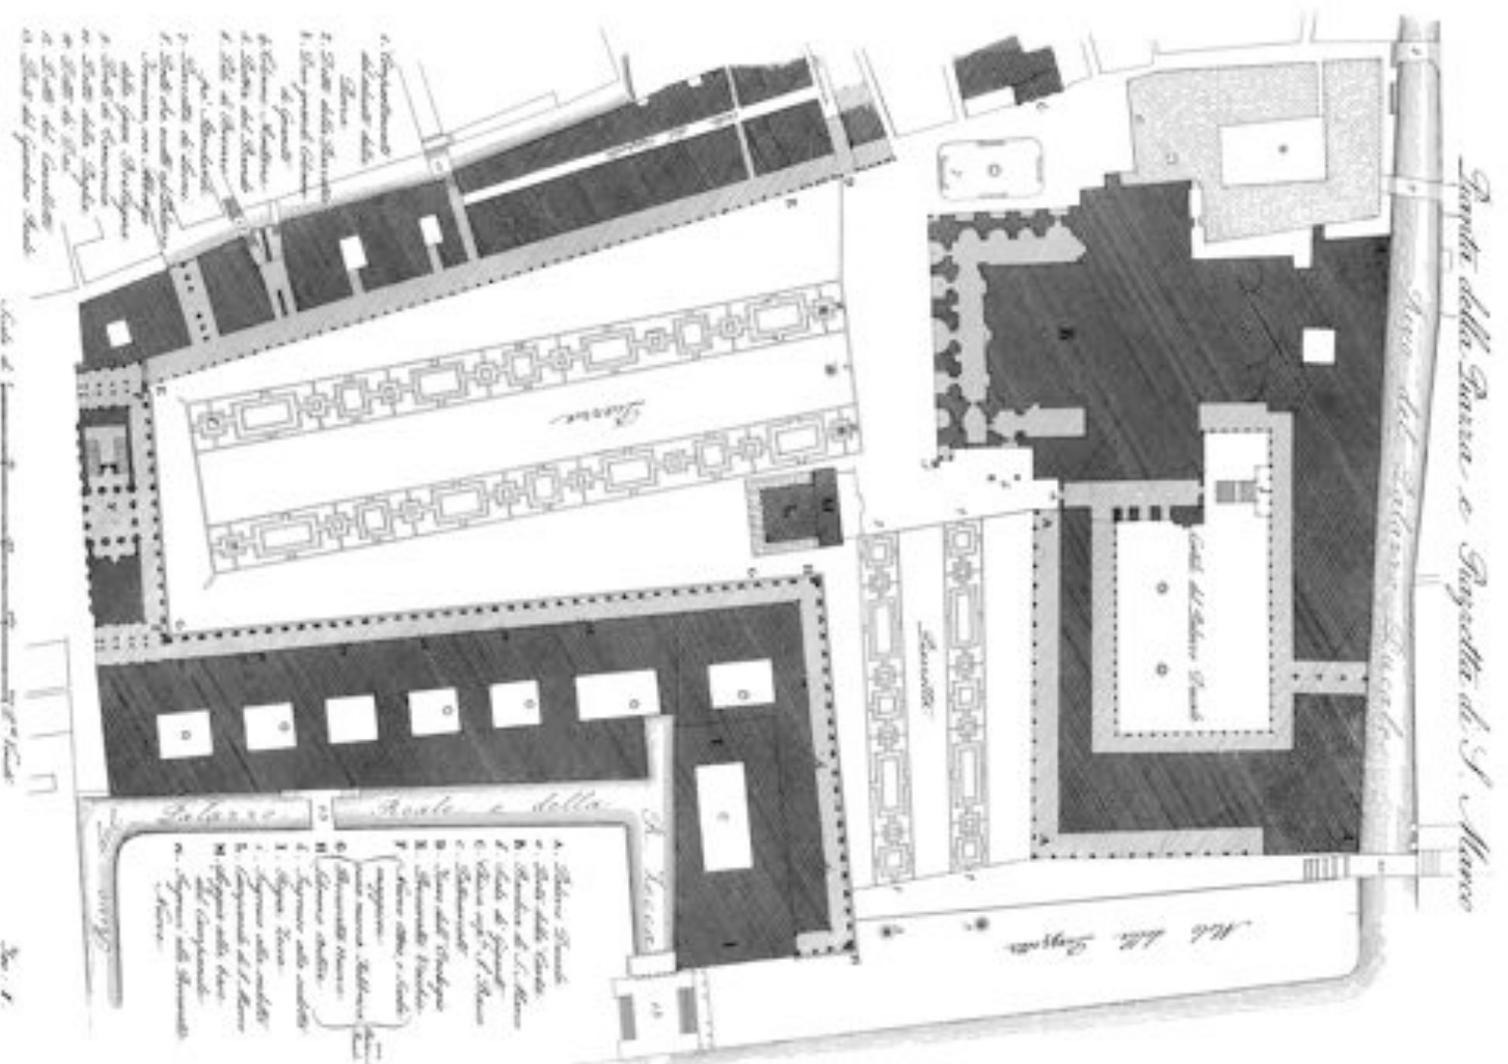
Der Grundriss der Piazza San Marco mit der Bezeichnung der einzelnen Gebäude.
